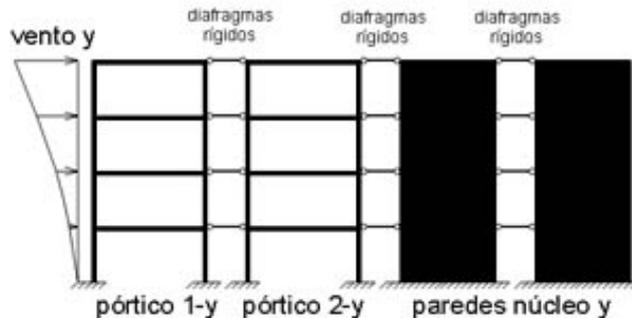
Composição dos pórticos planos e paredes do núcleo na direcção y [26]
